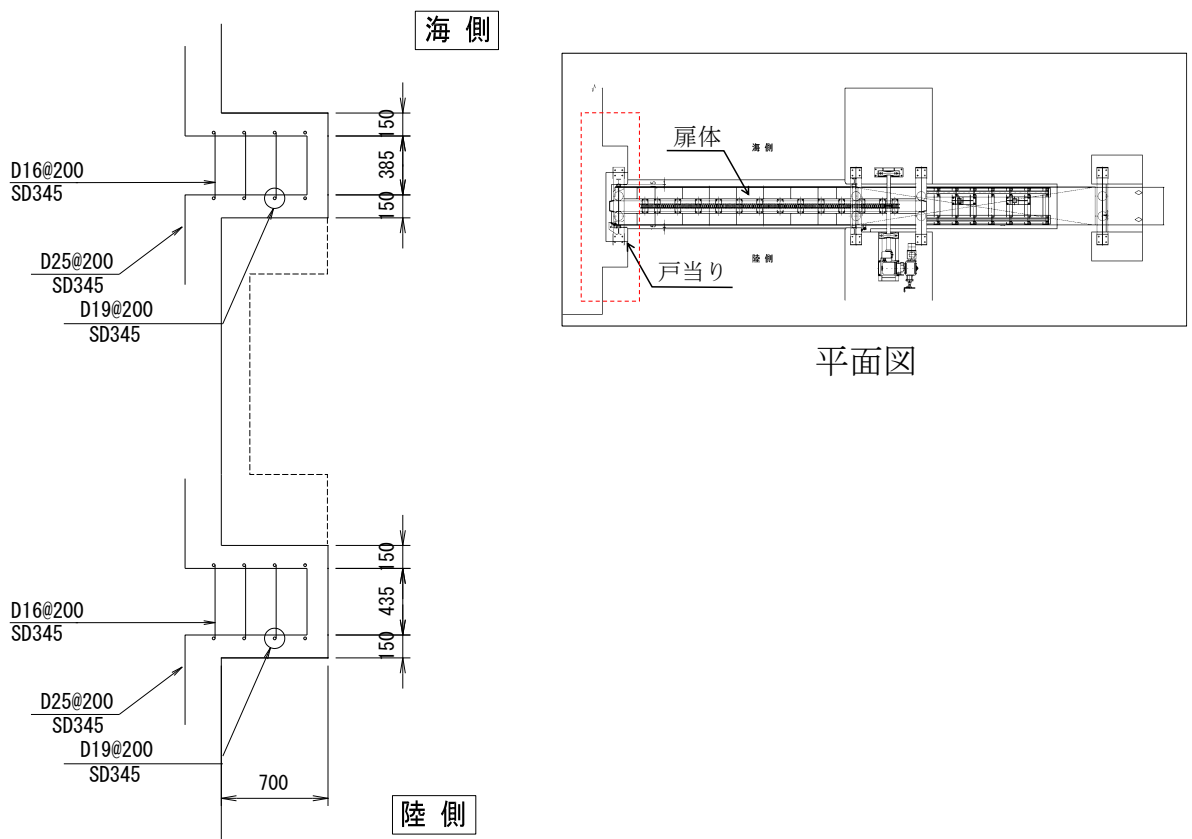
(1) 防波扉戸当り (RC支柱) の概略配筋図
